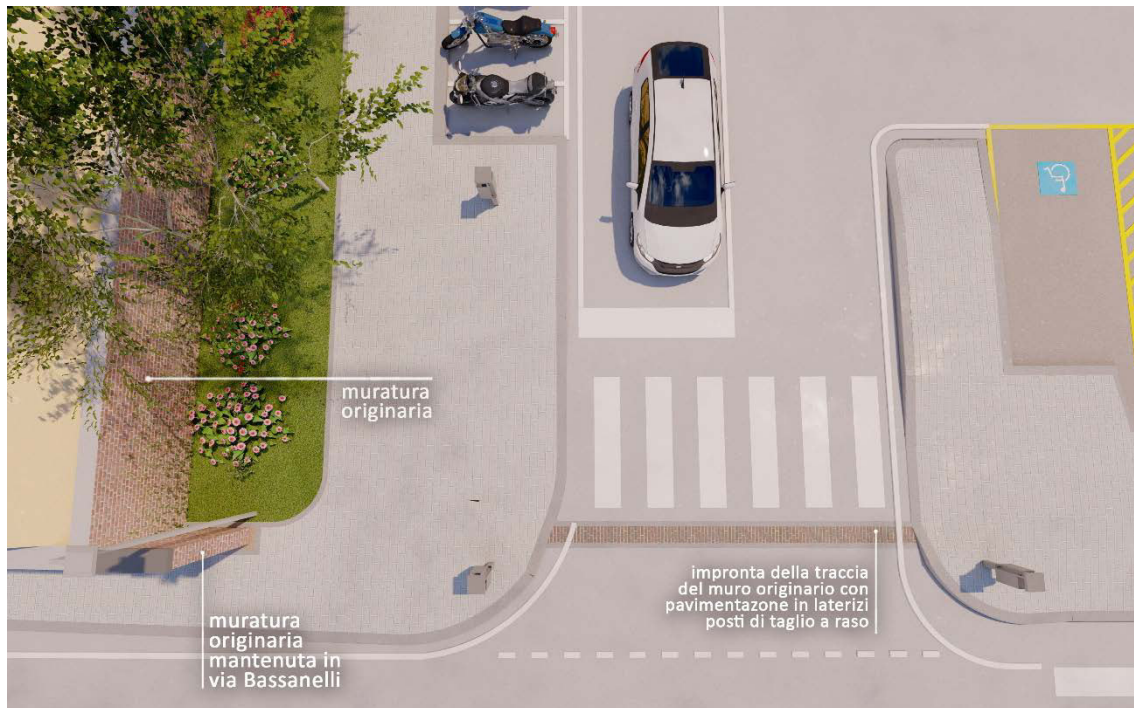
Vista dall’alto dell’ingresso al parcheggio
